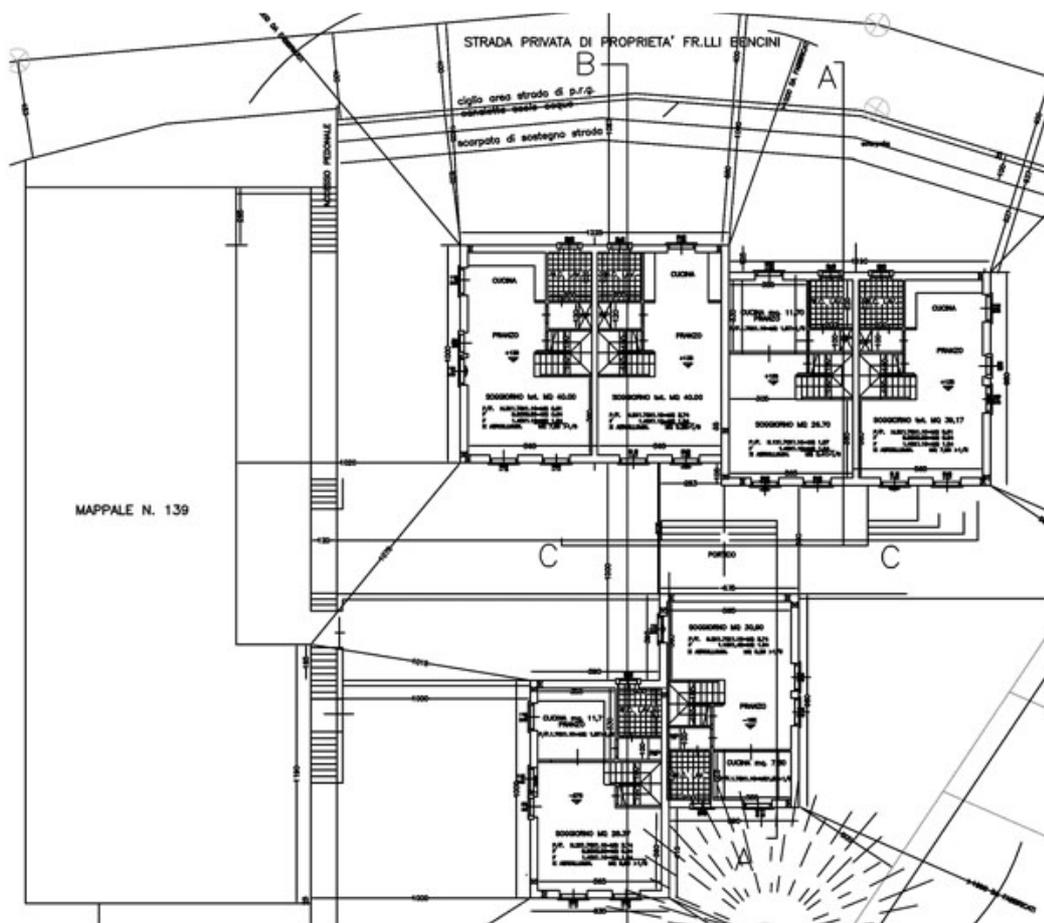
Planimetria del piano terra dei nuovi edifici a schiera.
